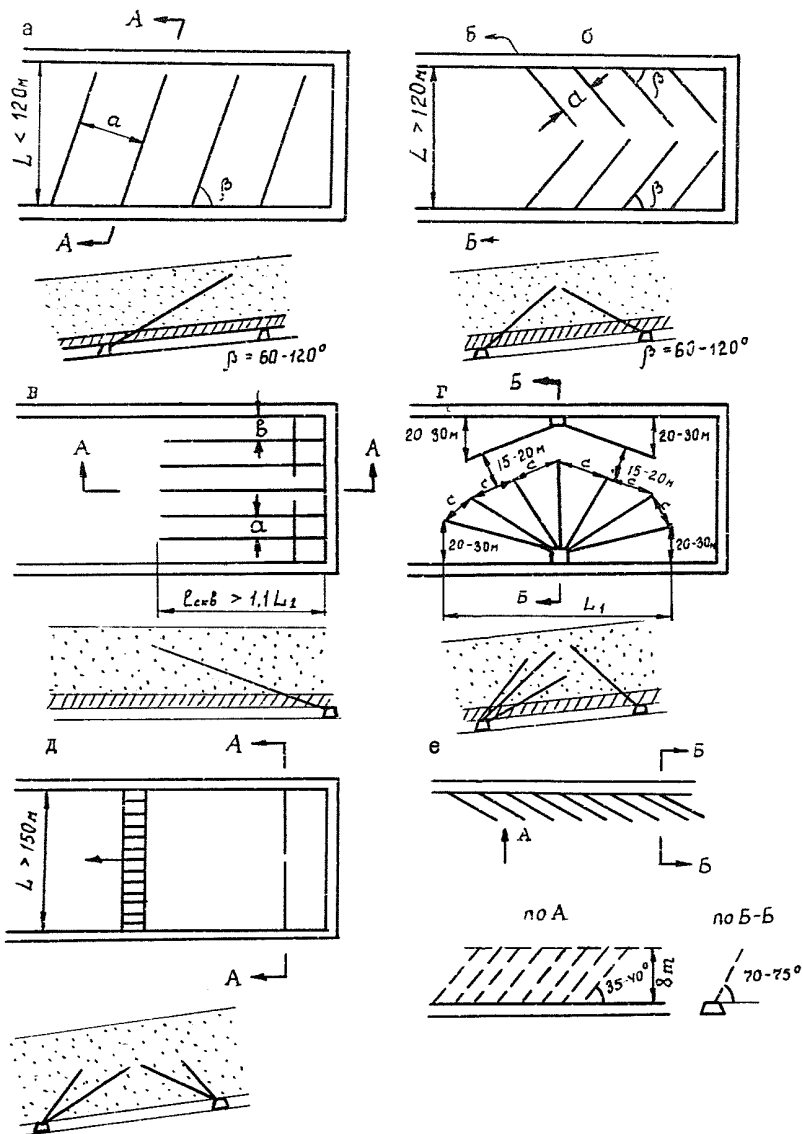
Схемы расположения скважин при первичных посадках кровли
